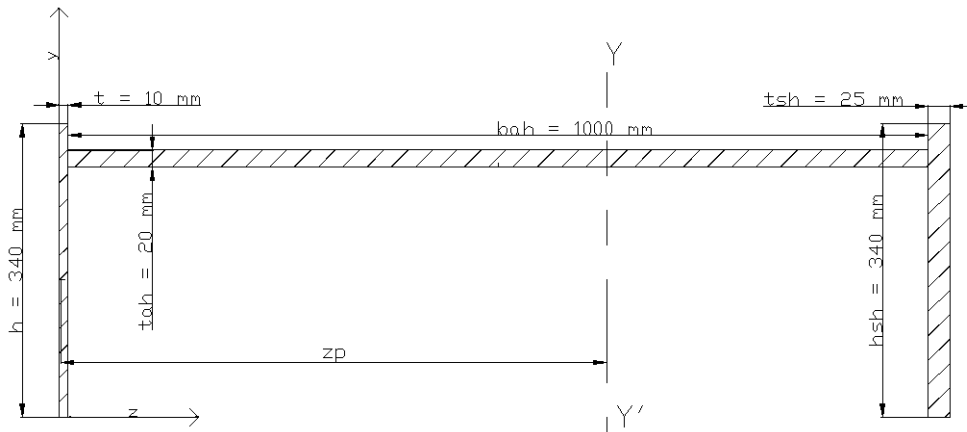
Figure VIII-I : Poutre élémentaire de la 1ère tranche de la porte soumise à flexion autour d'un axe vertical
